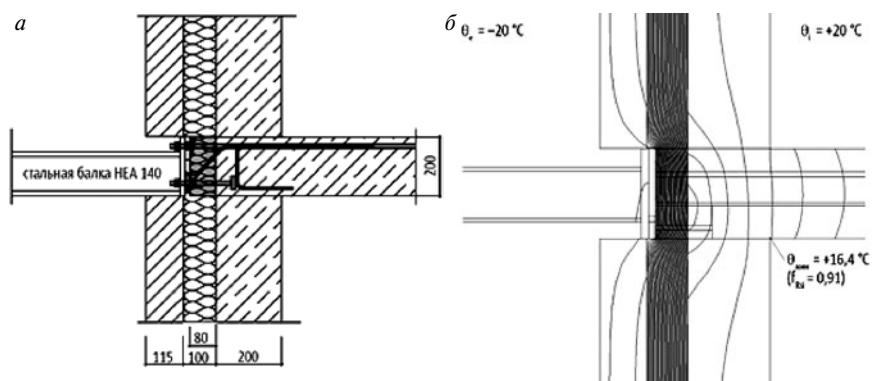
Соединение стальной балки HEA 140 с использованием Schöck Isokorb® тип KS14 для системы с теплоизоляцией: а – конструктивное решение узла; б – температурное поле узла
